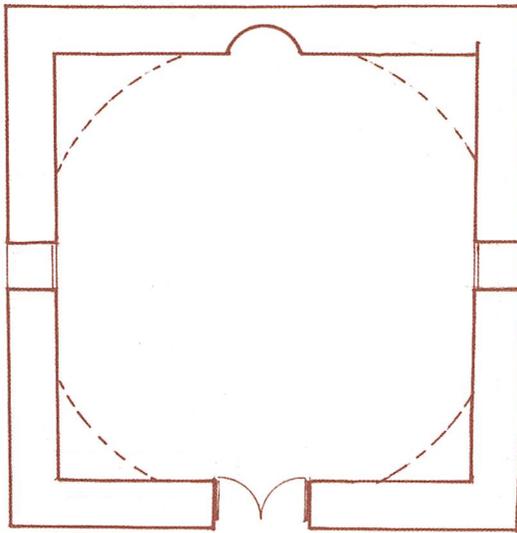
المسقط الأفقى لقبة وضريح أبو شوشة الفقى
